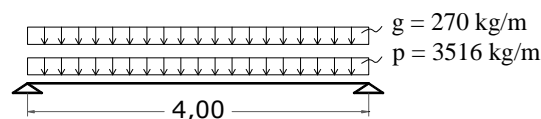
Esquema Estructural para el Cálculo de Viga de Fundación de Muros Portantes.
